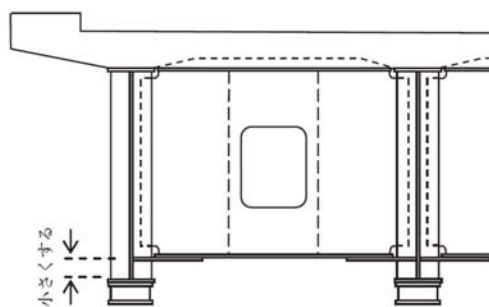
鋼桁における端横桁の構造の例 (道示Ⅴ編 図-解 12.5.2)
